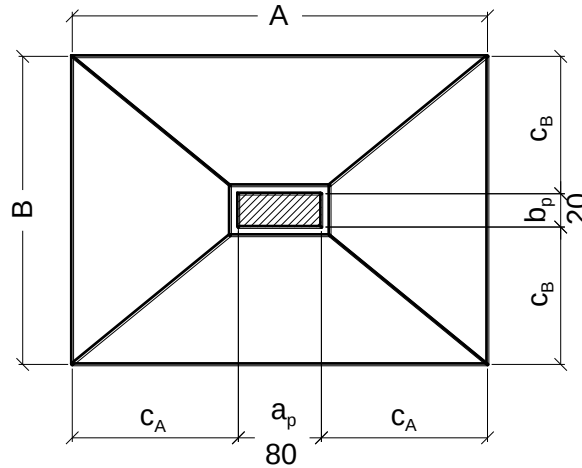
Dimensões (cm) do pilar e notações da sapata.
